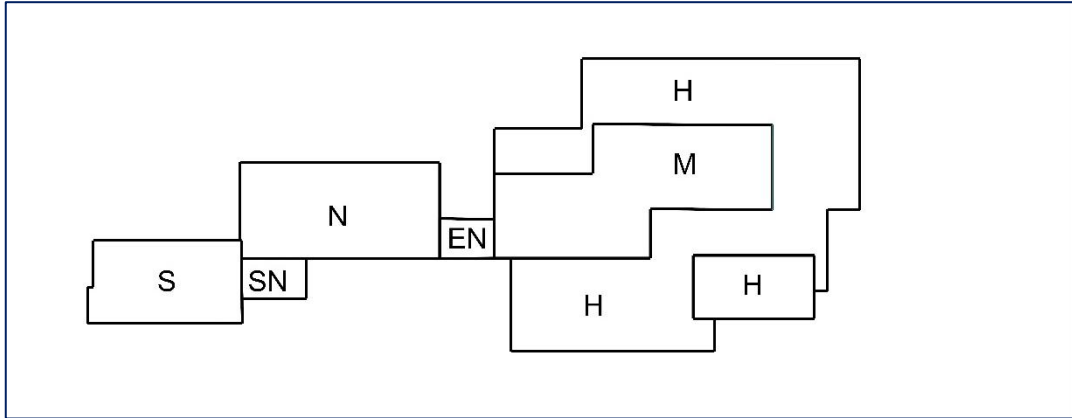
Schematischer Grundriss der Schule im Bestand
